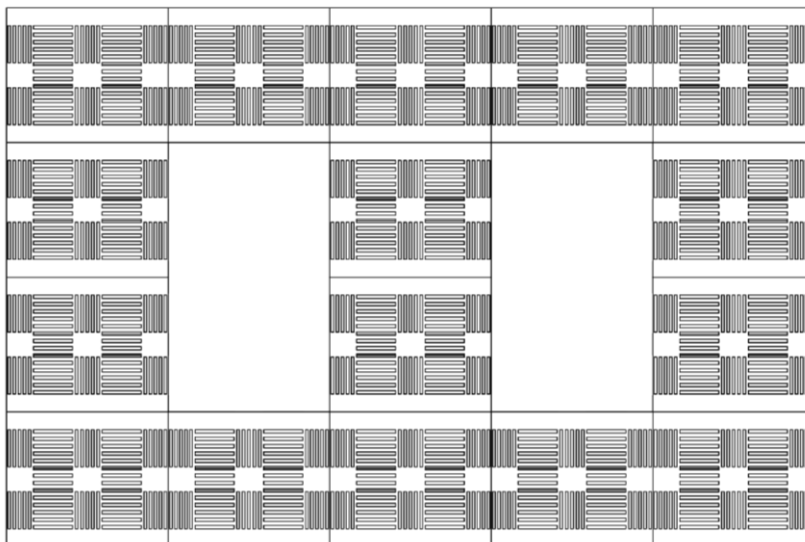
Cimentación de los 16 pallets de plástico colocados en 6 m. x 4 m.
